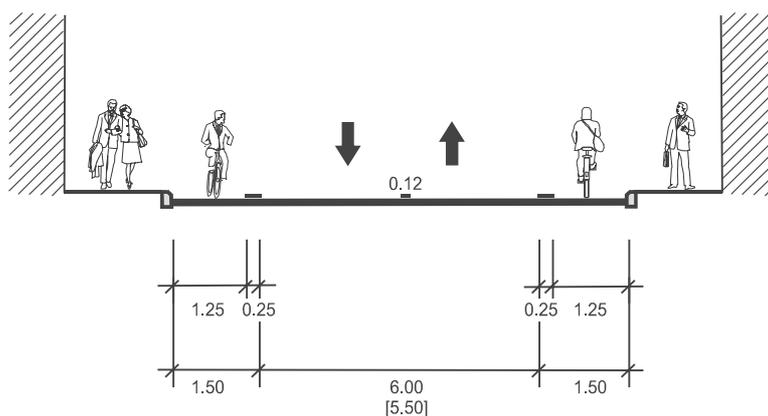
voie cyclable sur le bord de la chaussée sans bande de stationnement adjacente
